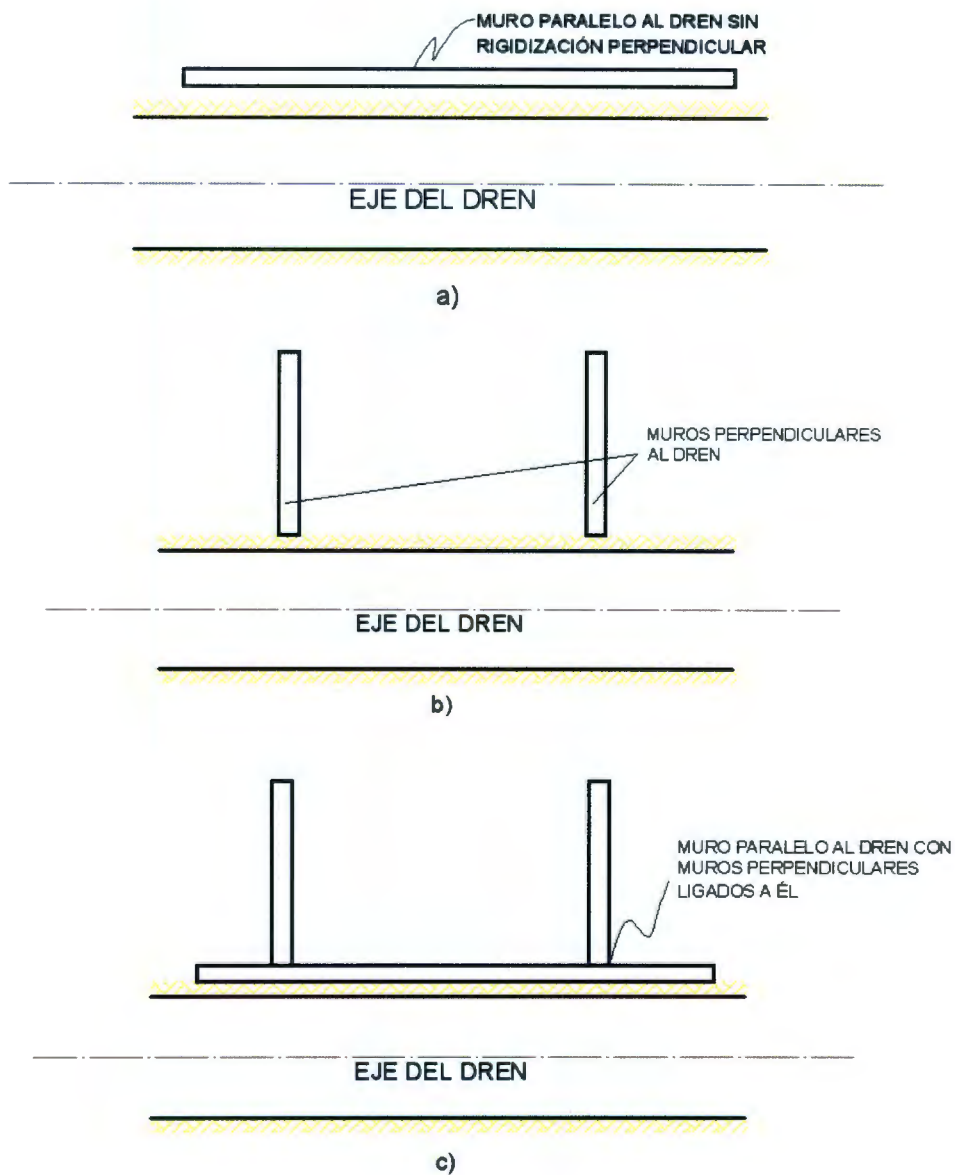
Diversas estructuraciones: a) muro paralelo al dren, sin muros perpendiculares que lo rigidicen por lo que su riesgo ante la construcción del dren es mayor, b) Muros perpendiculares al dren con menor riesgo y c) Muro paralelo al dren con muros perpendiculares ligados a él, por lo que disminuye su riesgo.
